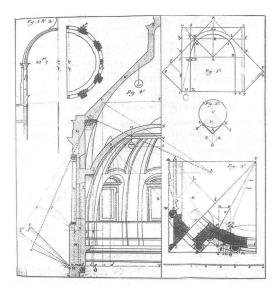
Dimensionado del estribo de las bóvedas. Aplicación a la cúpula proyectada por Soufflot en 1764 (Gauthey 1771)
